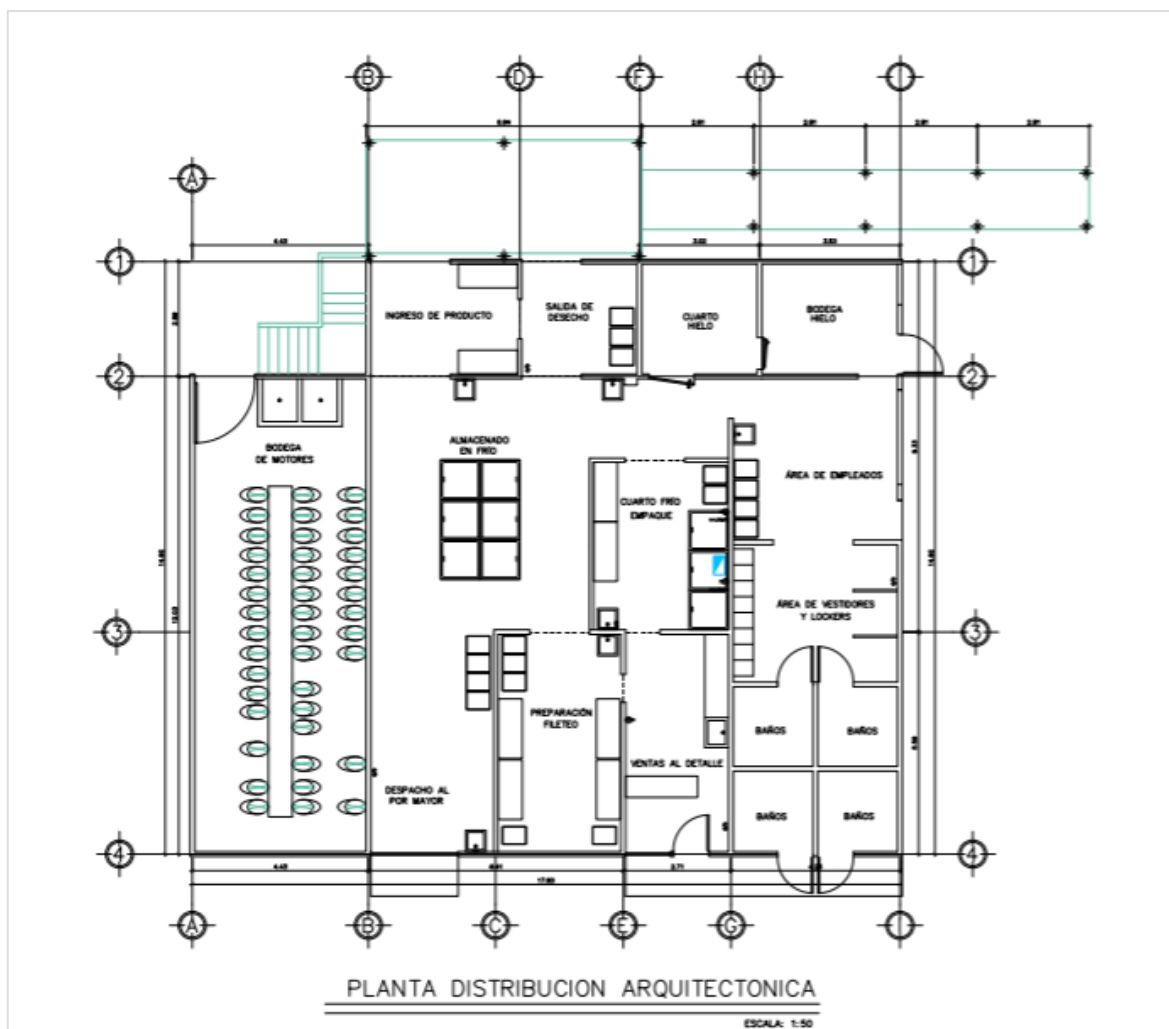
Propuesta de una planta de distribución arquitectónica.
